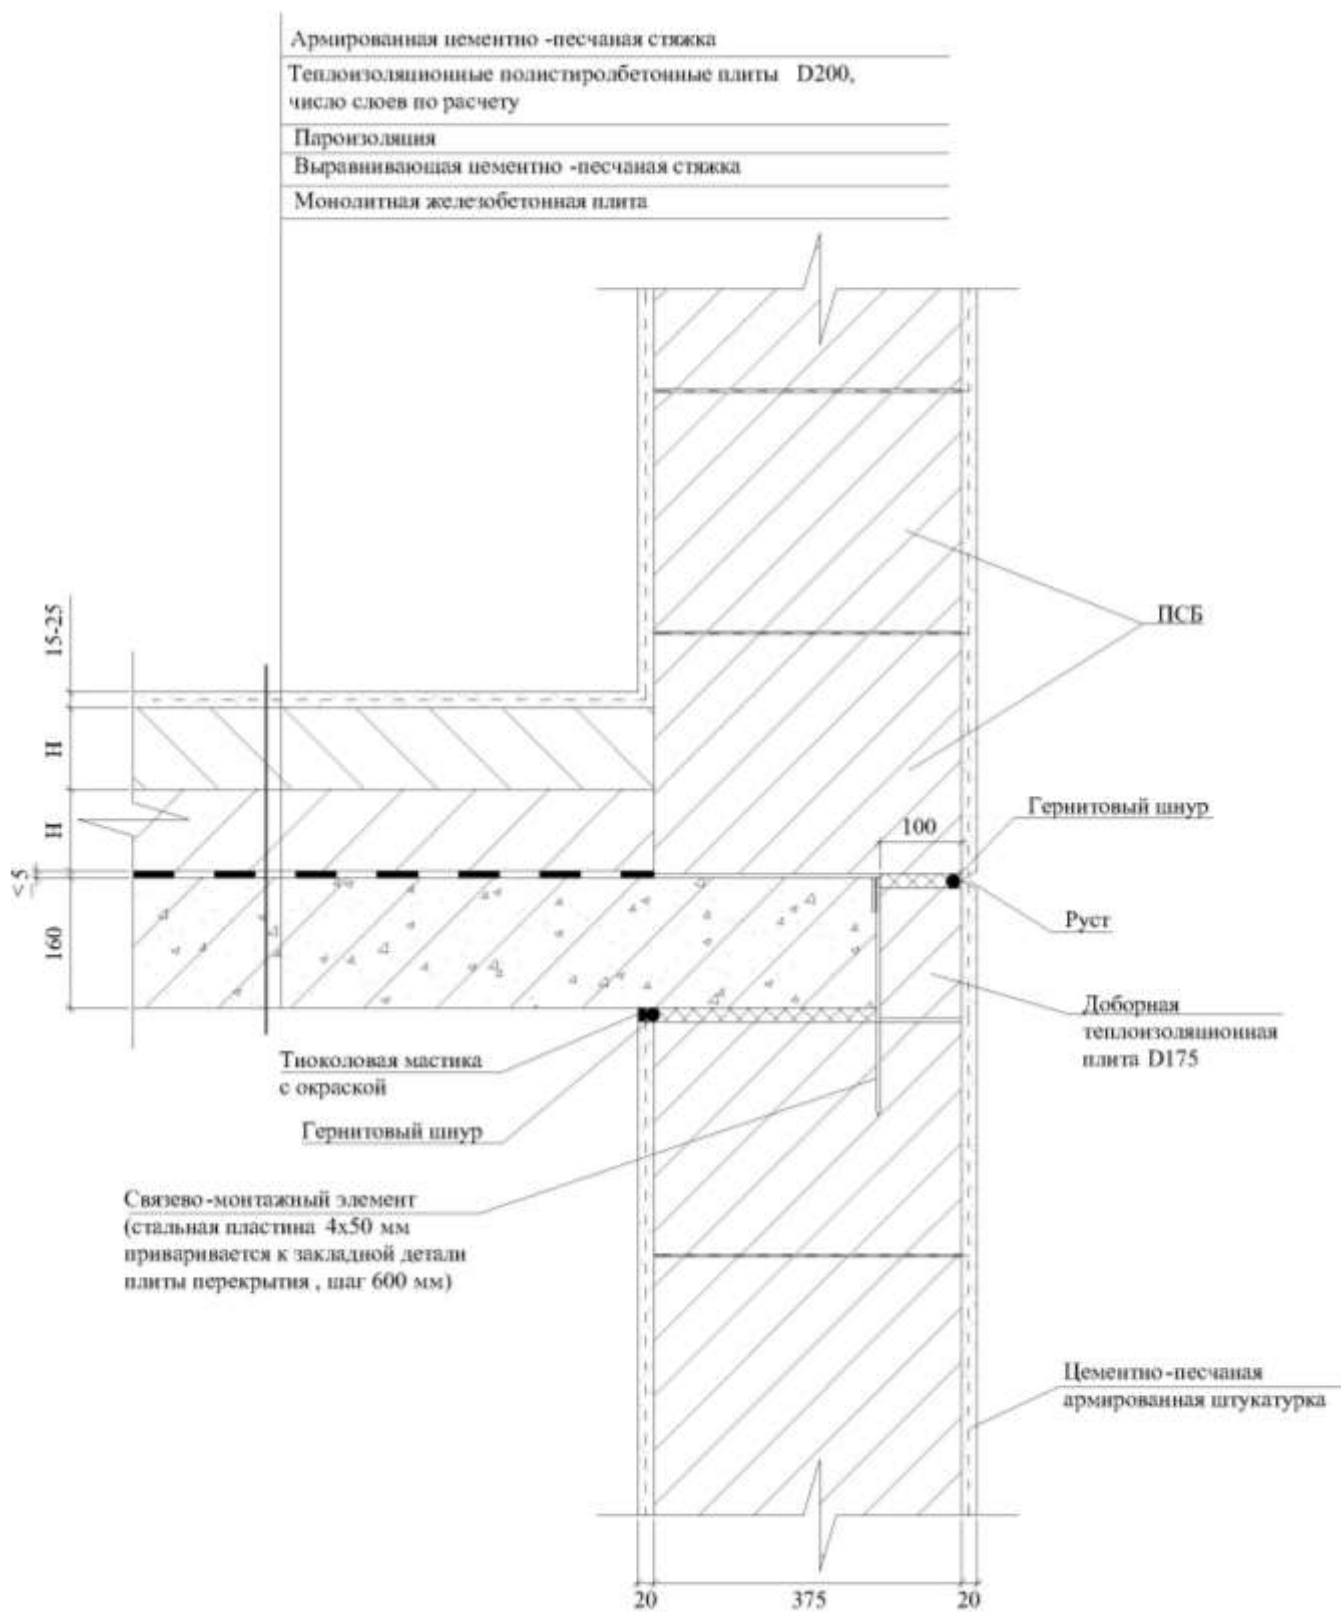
Утепление чердачного перекрытия с использованием теплоизоляционных плит или монолитного полистиролбетона
